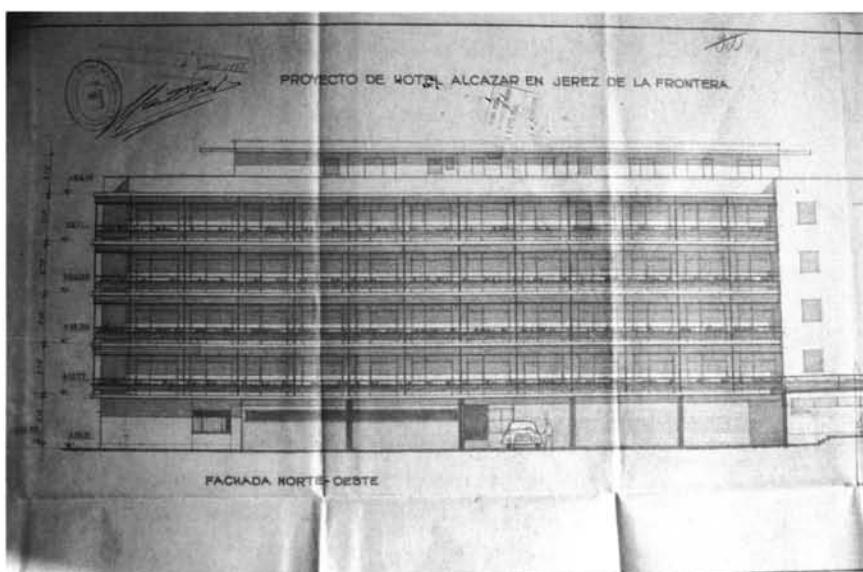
Luis Gutiérrez Soto. Proyecto de Hotel Alcázar. Fachada noroeste. 1958.
